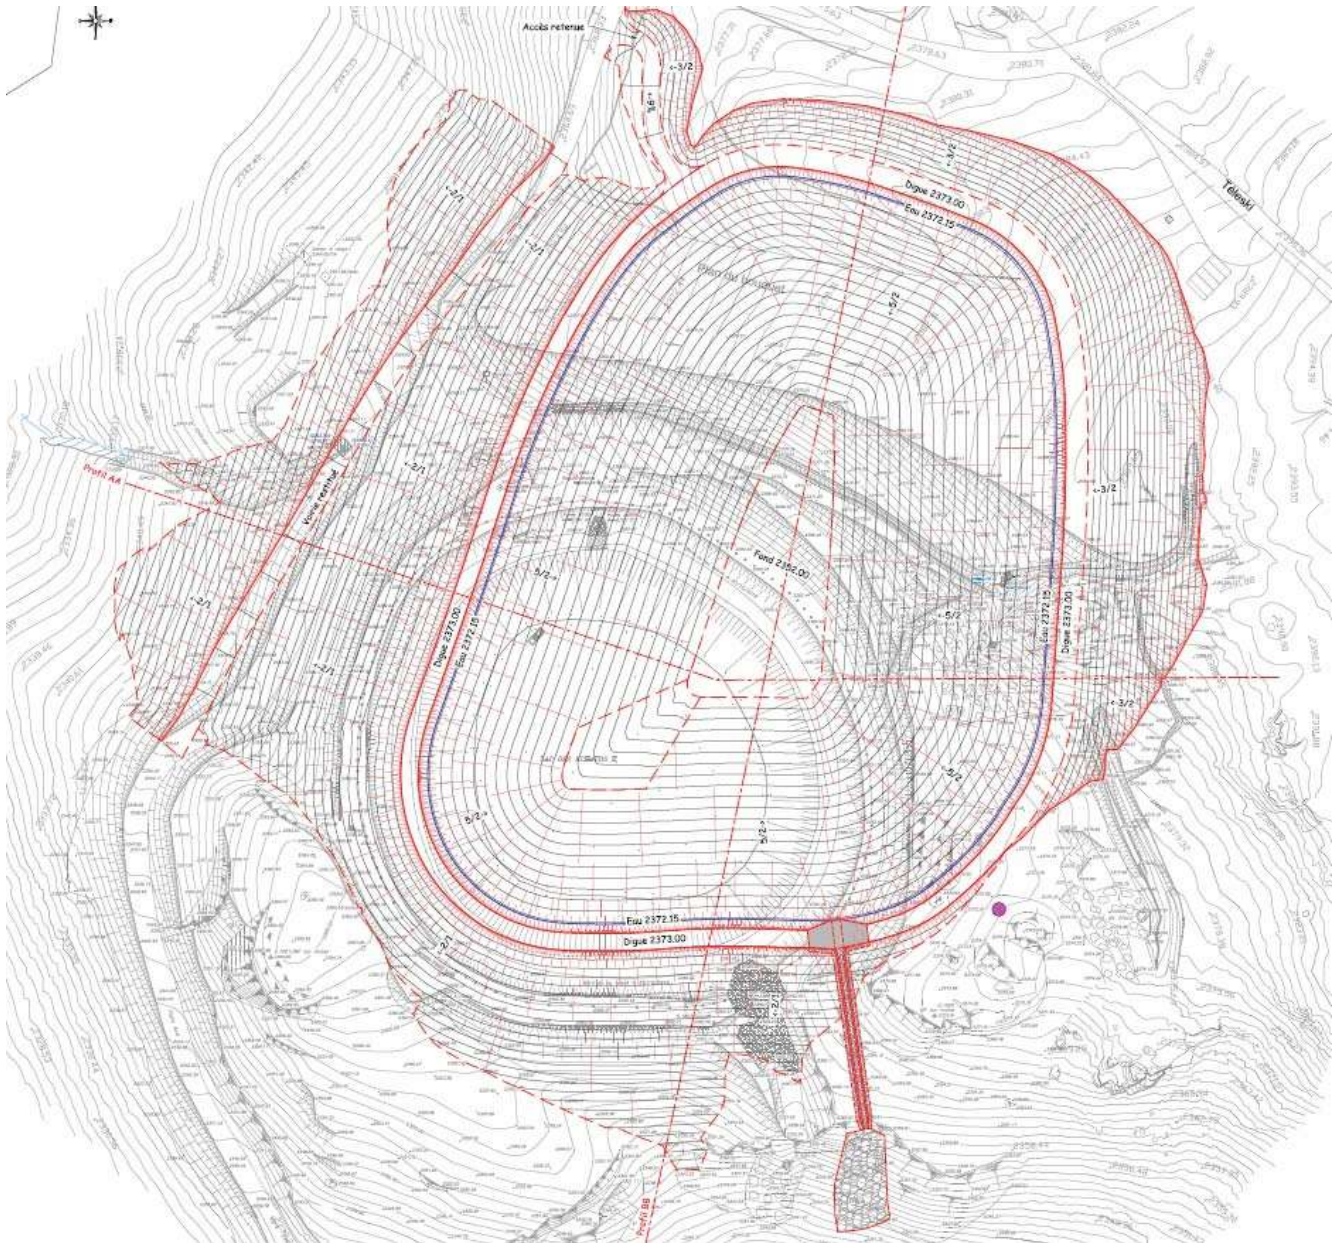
Extrait du plan de masse de la nouvelle retenue (indice G)
